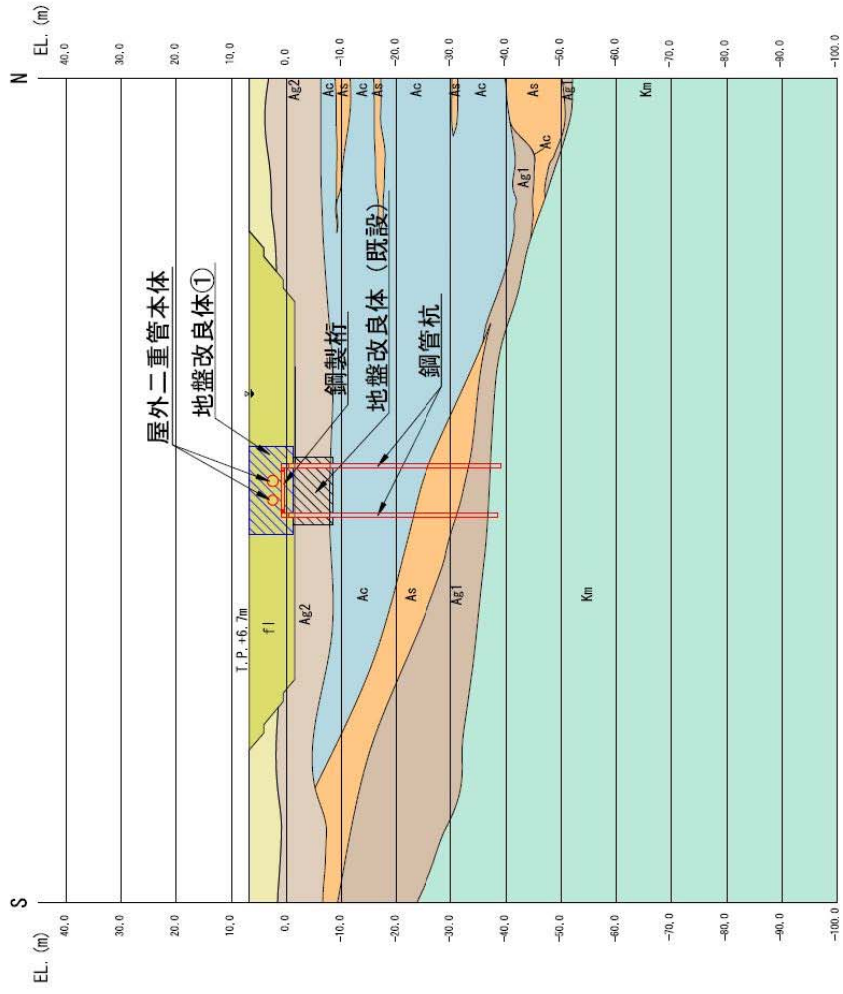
(2) 屋外二重管の評価対象断面図 (B-B 断面)
